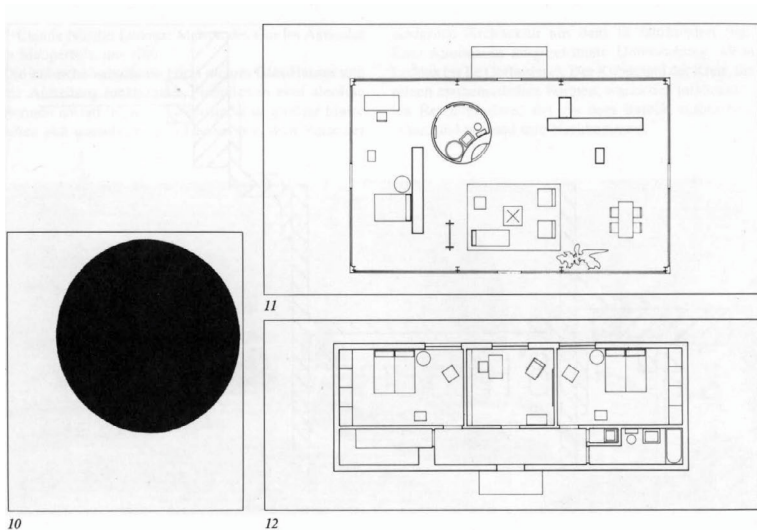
"Kasimir Malewitsch: Suprematist Element: Circle–1913," "Haus Johnson: Grundriß des Glas-Hauses," and "Haus Johnson: Grundriß des Ziegelbaus," from Philip Johnson, "House in New Canaan, Connecticut," Texte zur Architektur (Stuttgart 1982), 130–143, here: 138.
